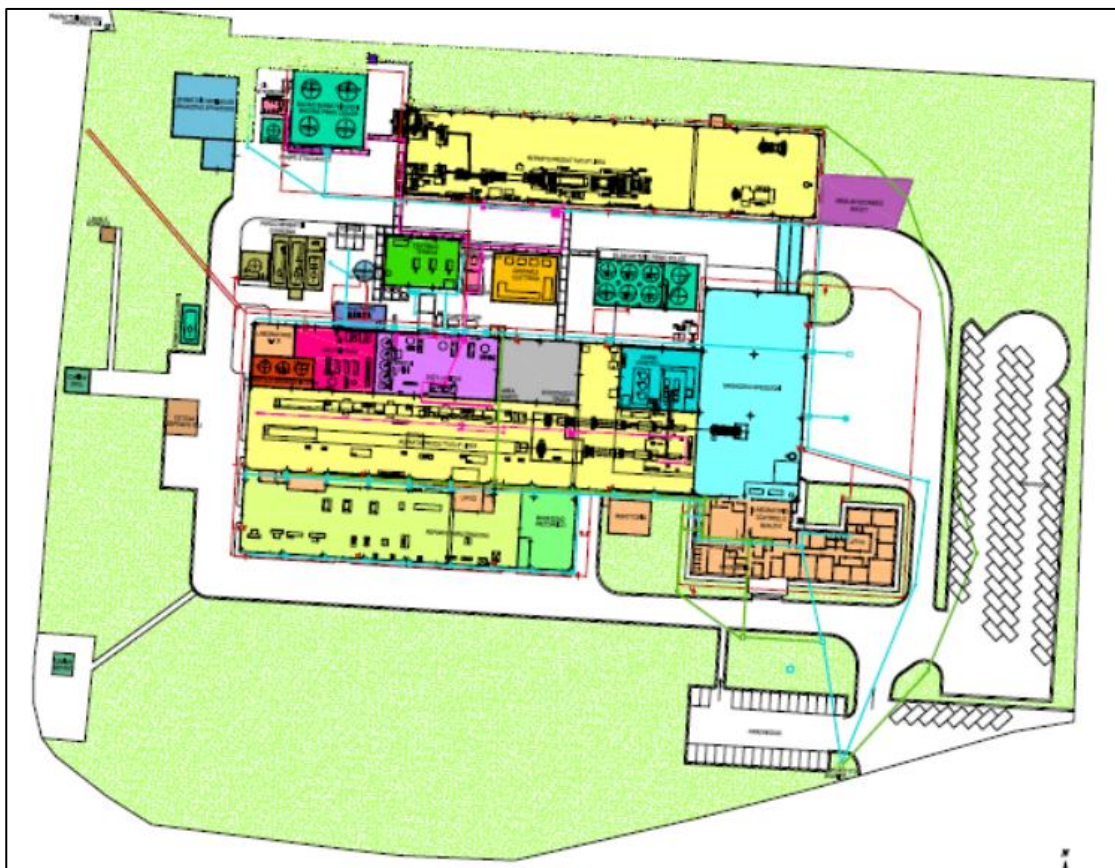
Estratto dalla planimetria dello stabilimento (Allegato 1)
